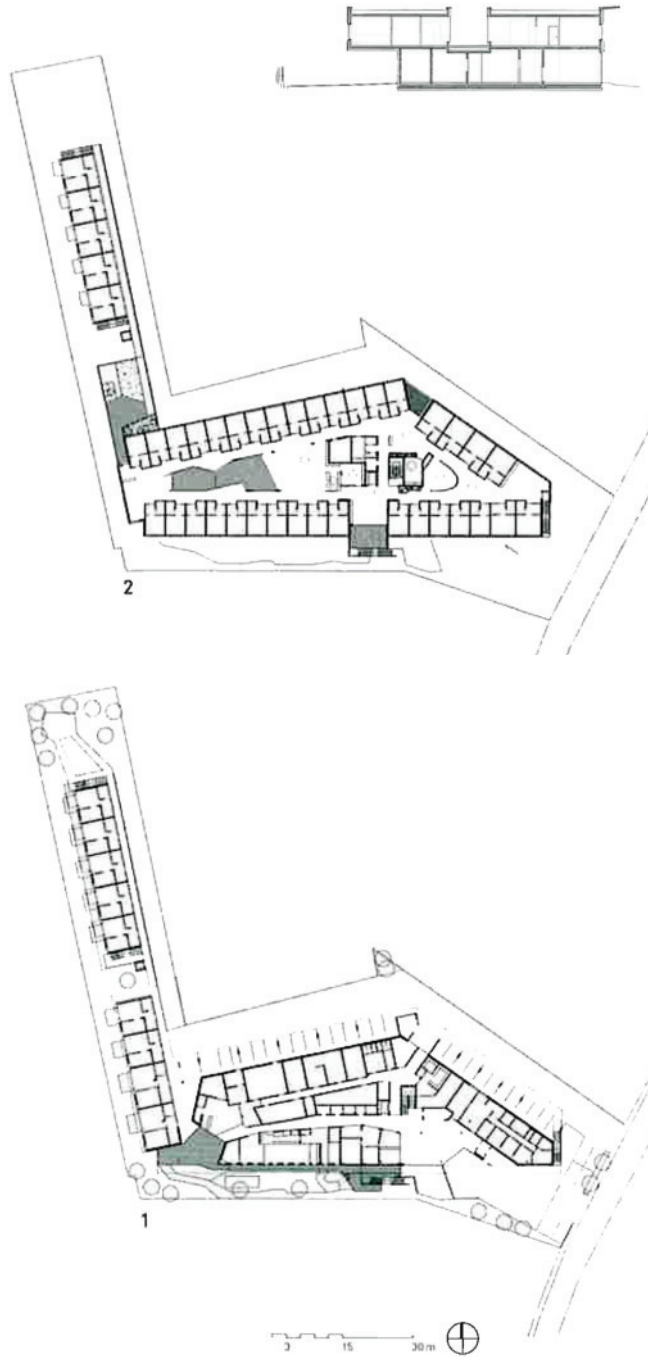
Grundriss Erdgeschoss und Obergeschoss, Querschnitt
